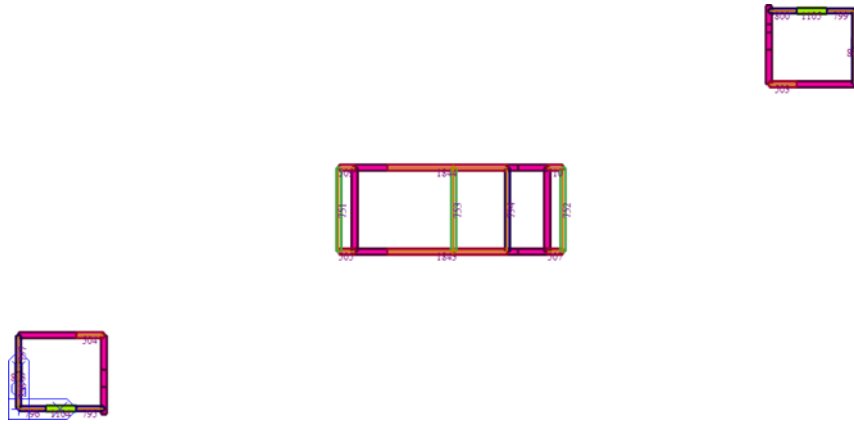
Statik analiz modelinde yapının 2. normal kat tavan kalıp planı
